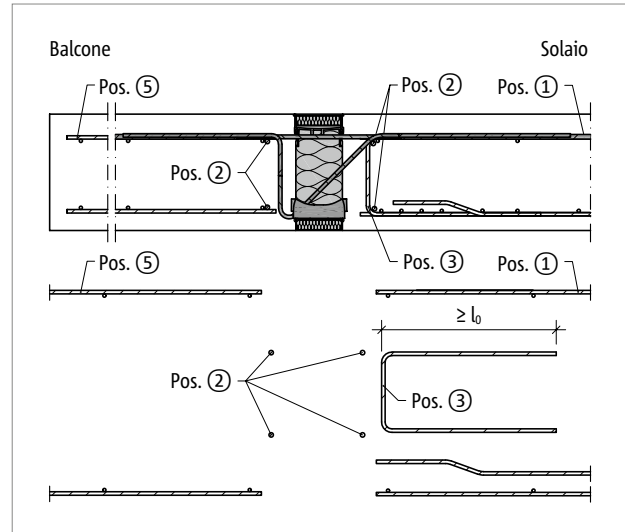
Schöck Isokorb® T tipo K-M1-M11: armatura in opera con appoggio indiretto
